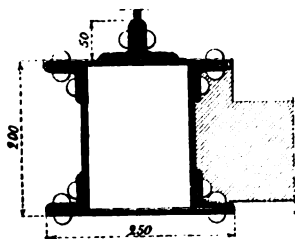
Pilier d'angle de pan de fer (poutre tubulaire).
